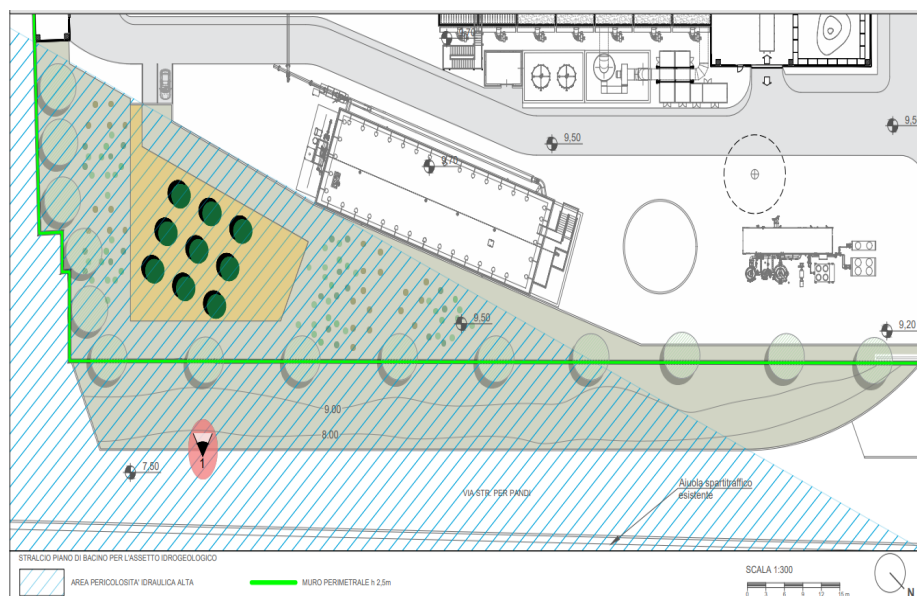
Estrapolazione dall'Allegato D. T 38 REV 00 –Stralcio planimetria generale di progetto
